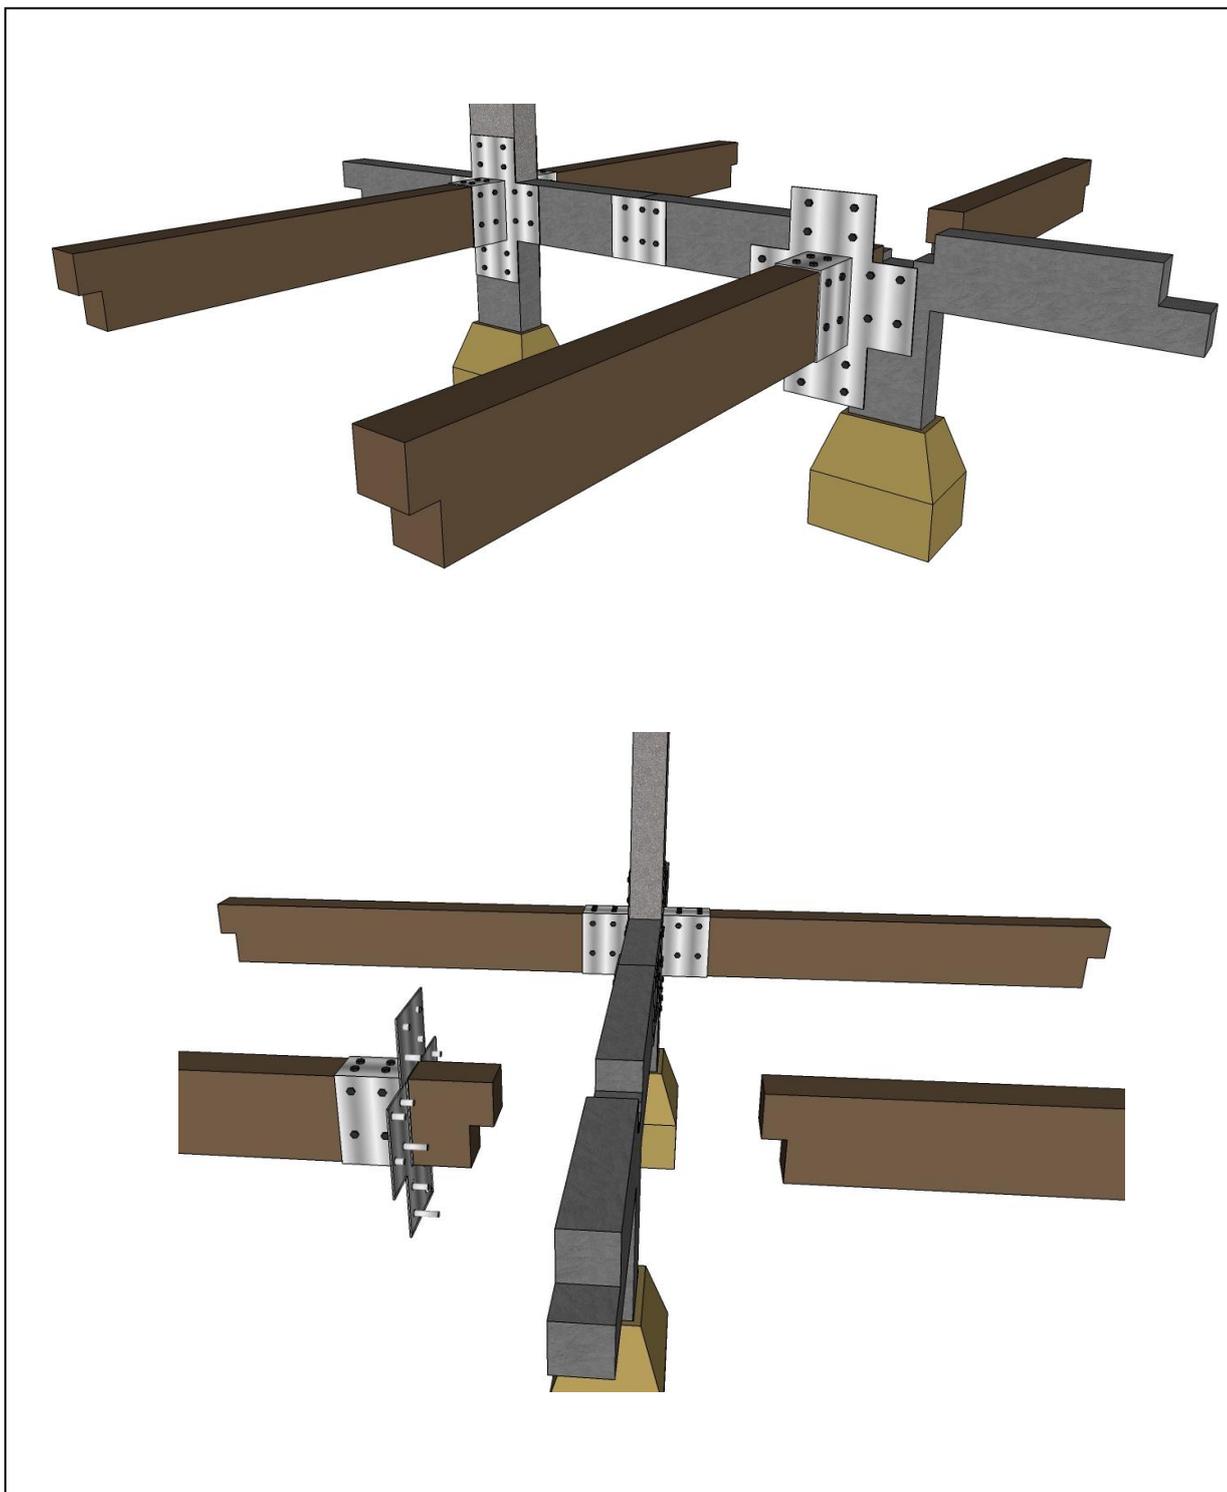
Exemple de montage amorce- longrine et amorce- longrine et semelle en beton
